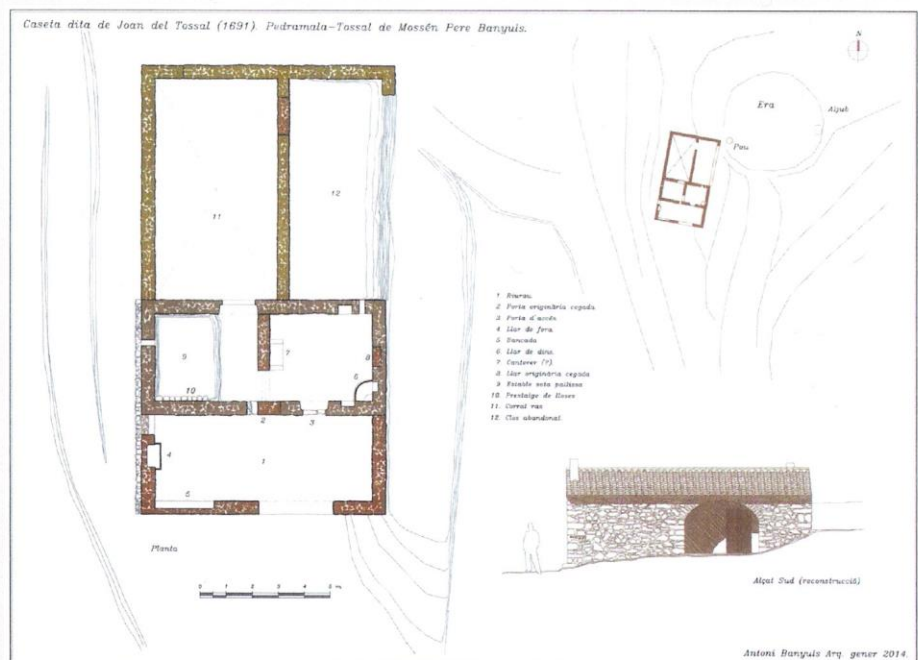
Reconstrucció en planta i alçat frontal de la casa del Tossal
